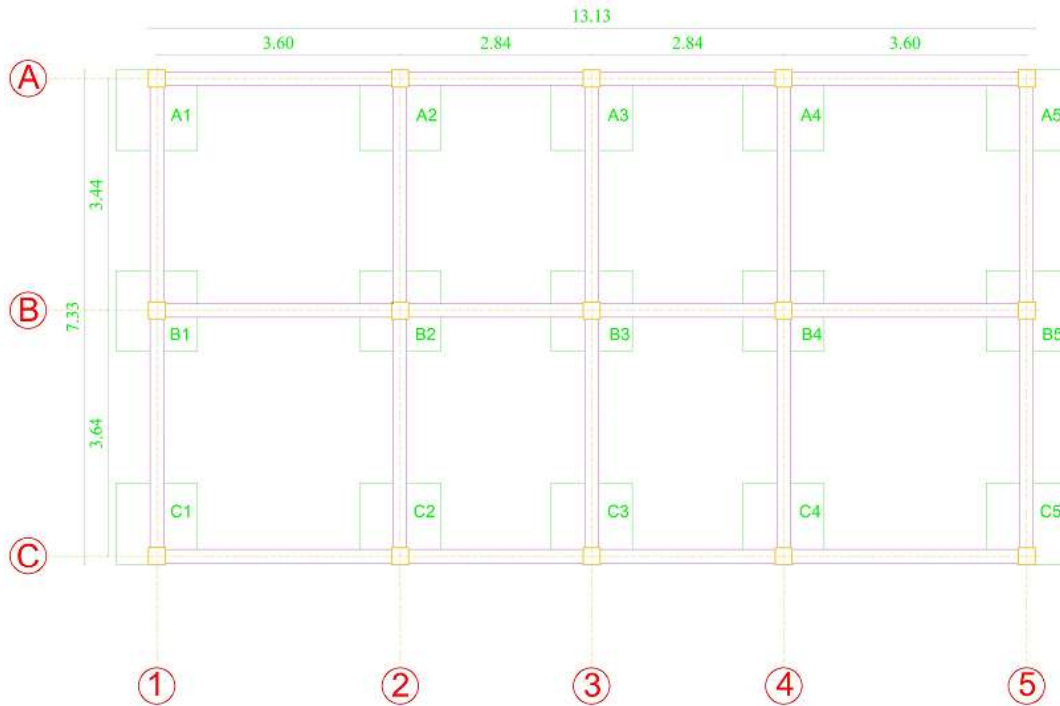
Diseño de cimentación (Zapata Aislada 120x30 cm)
